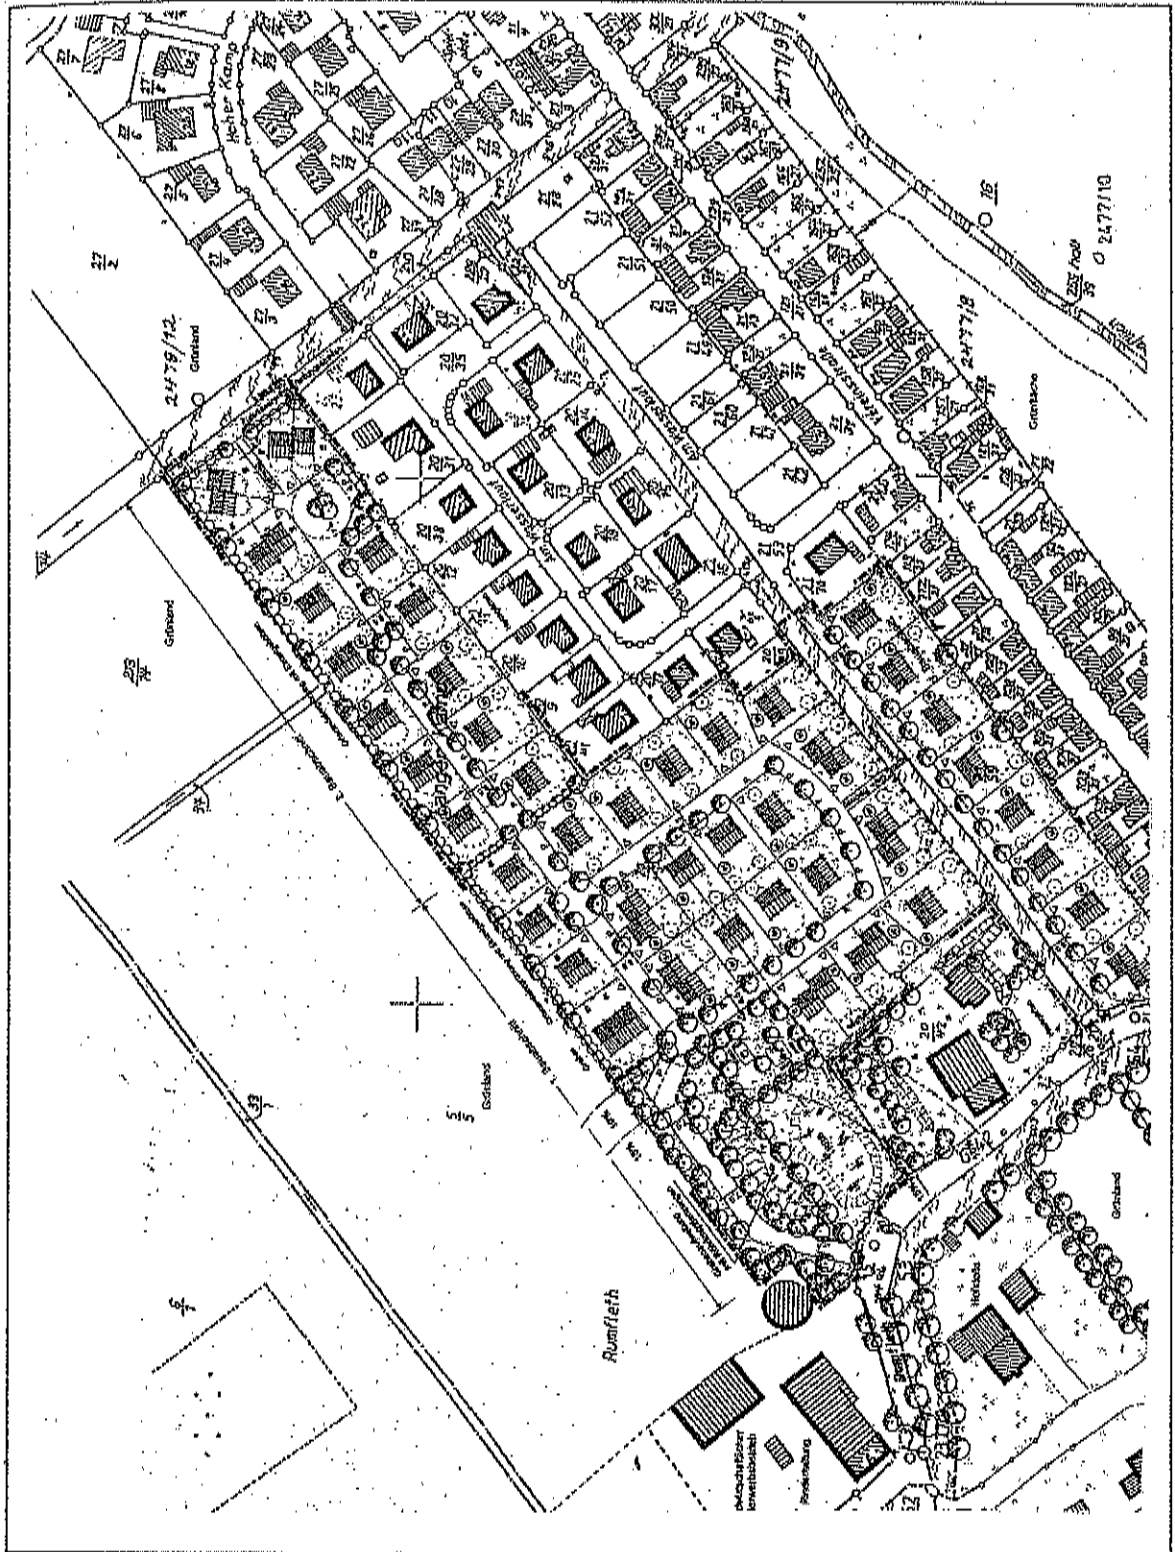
Planausschnitt aus „Städtebauliches Konzept - 2. Entwurf“ mit Grünordnungsplanung zum Bebauungsplan Nr. 3, zuletzt ergänzt am 05.12.2000, unmaßstäblich
